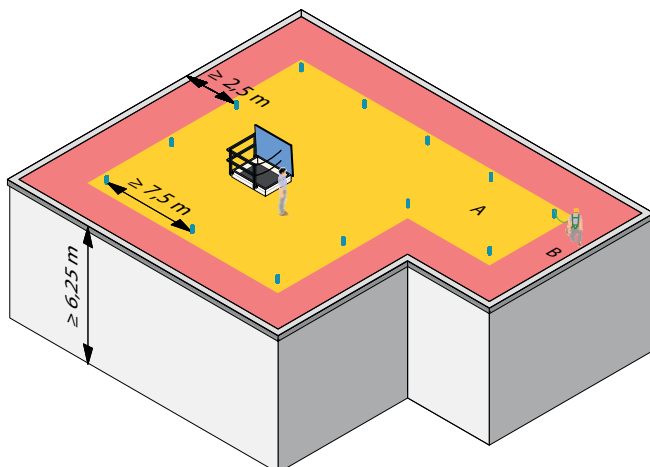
Ausstattungs-klasse 1: EAP am Dachrand entlang der Geometrie des Gebäudes angepasst
